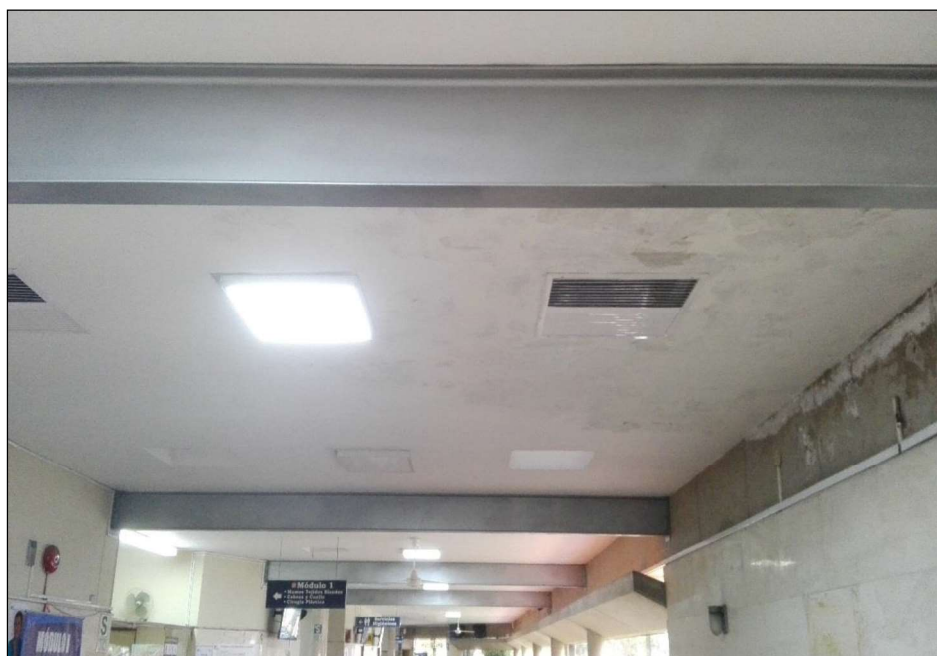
Vista de la infraestructura de material prefabricado que ha sido reforzada en la base
